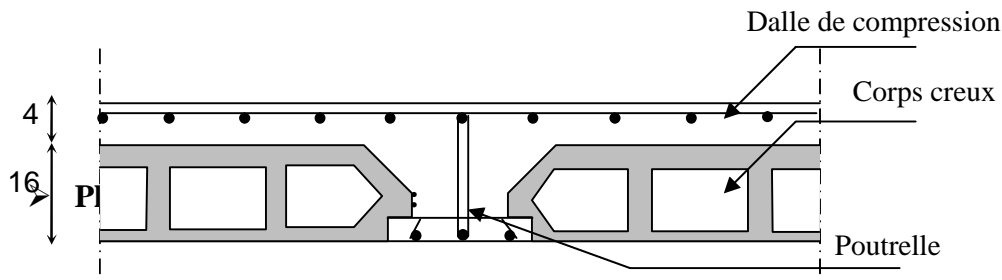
Schéma descriptif d'un plancher en corps creux
